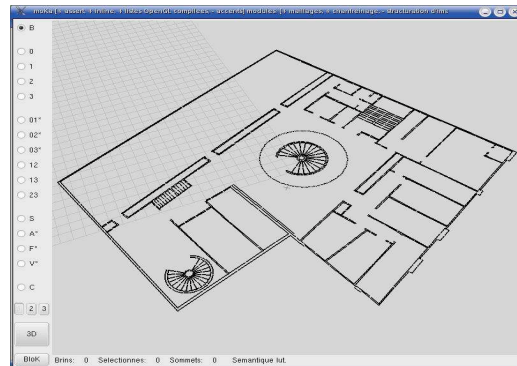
Plan 2D reconstruit. Exemple de reconstruction de bâtiment existant
